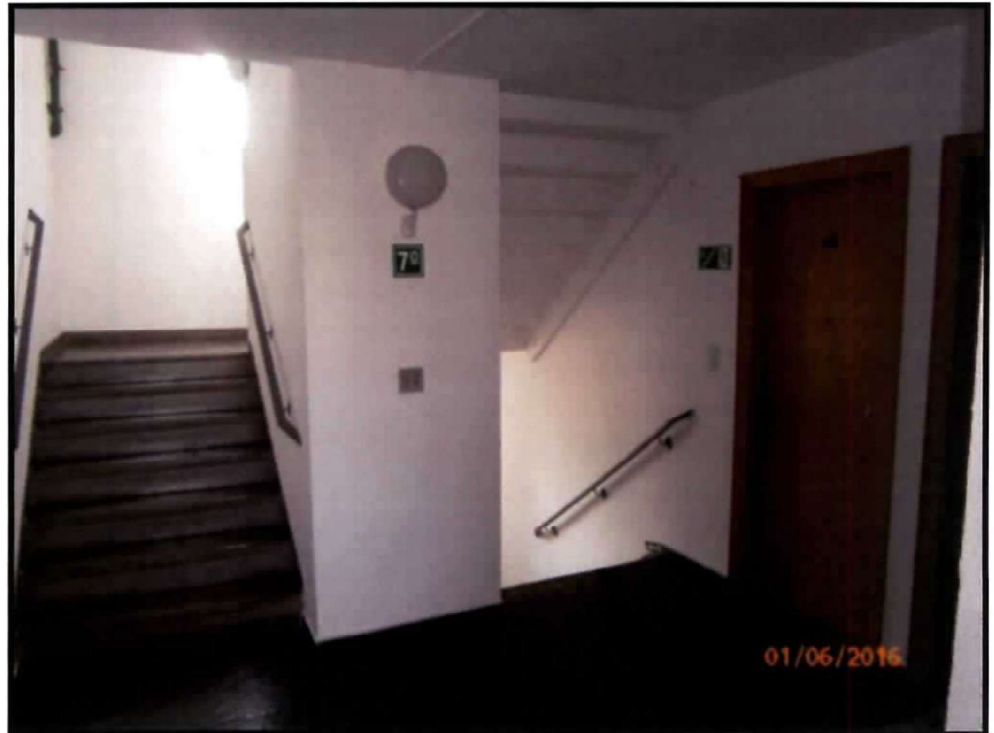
Detalhe do hall de entrada e a porta de acesso ao apartamento avaliando, que se encontrava fechado.
